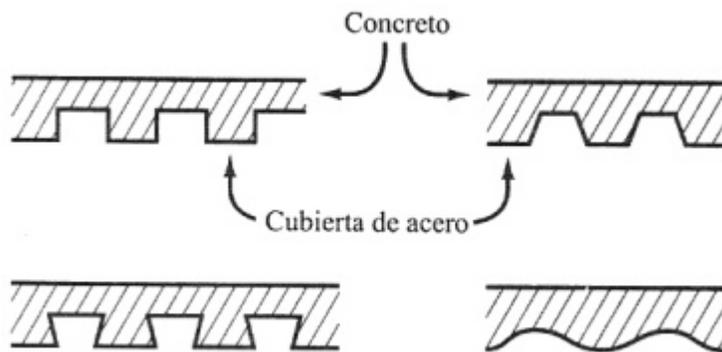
Algunos tipos de cubierta de acero de losas para pisos
